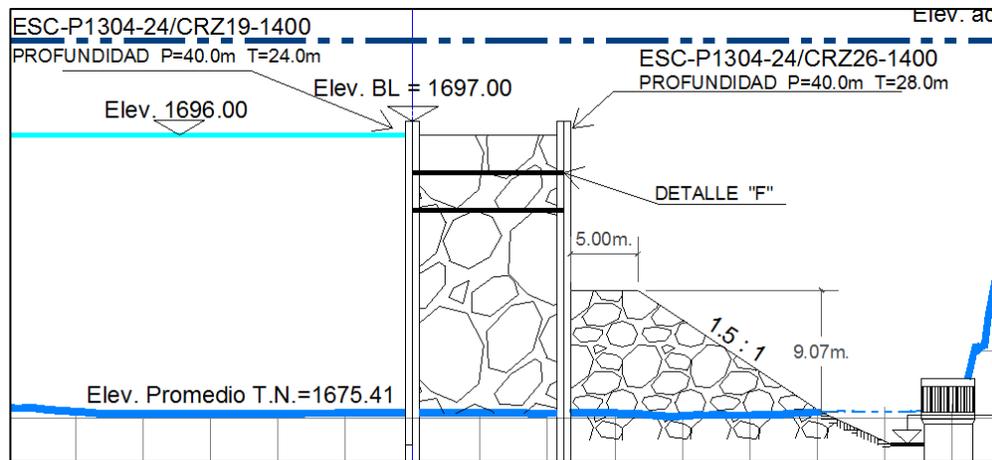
Sección tipo de berma a utilizar en la pared interior, del sistema combinado de doble muro..
